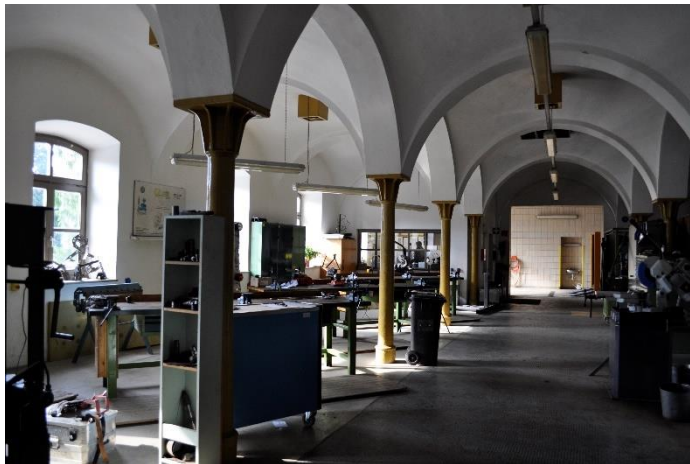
Erdgeschosshalle mit gusseisernen Stützen
